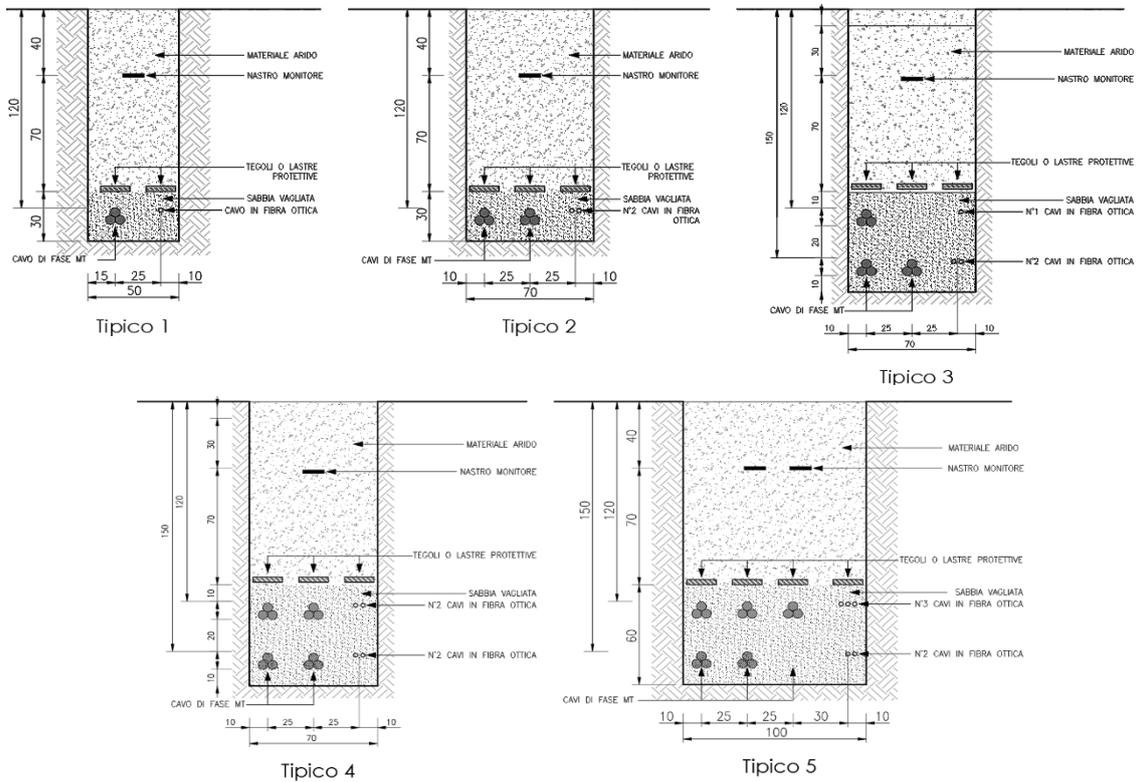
Sezioni tipo Disposizione Cavi MT Su strade sterrate
